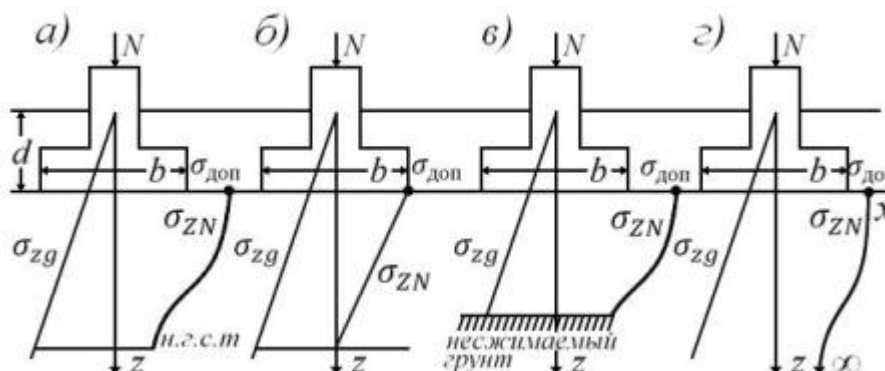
Расчетные схемы определения осадок фундаментов:
